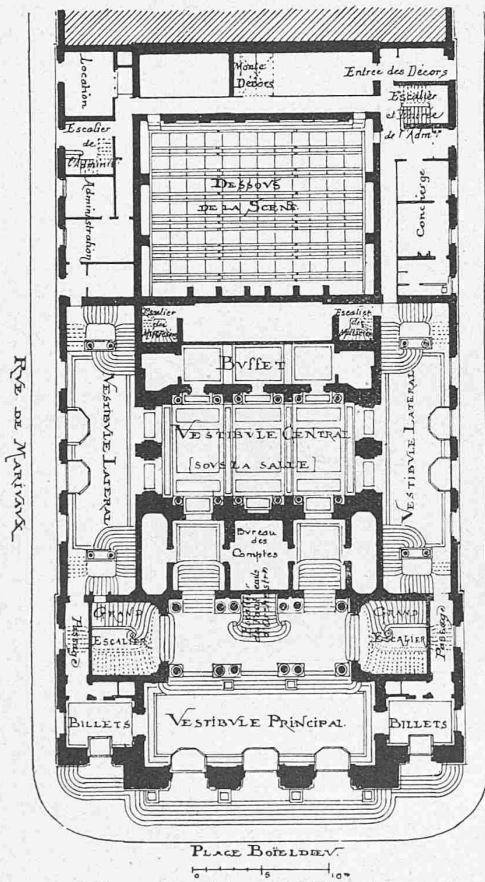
Grundriss vom Erdgeschoss.
